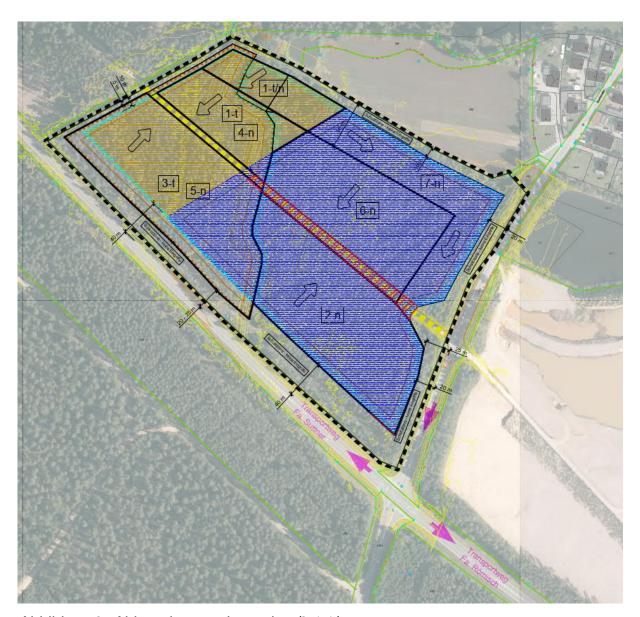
Abbauplanung, Lageplan /2.1.1/
